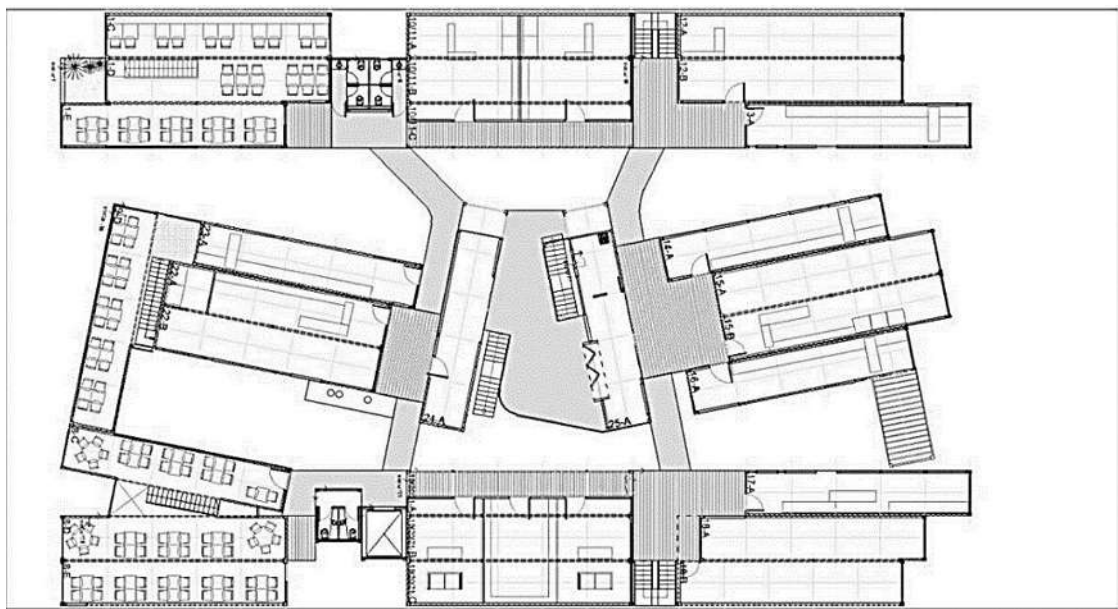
Planta alta de Quo Container Center. Fuente: ARQA Arquitectura Sustentable.
